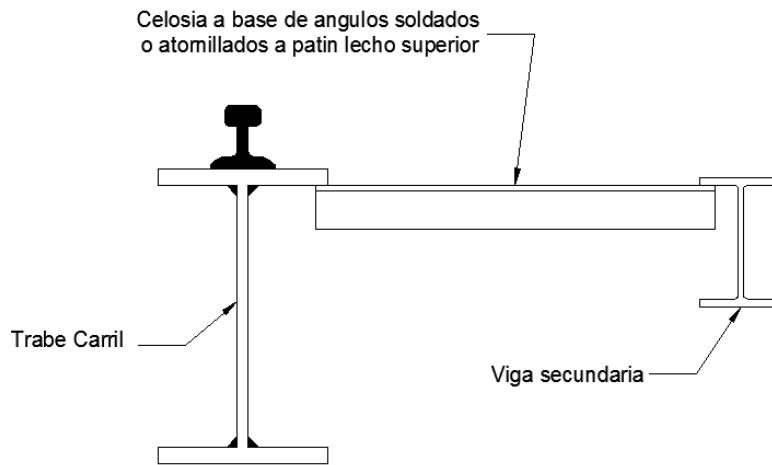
Trabe carril rigidizada lateralmente hacia trabe secundaria unida con celosía a base de ángulo
